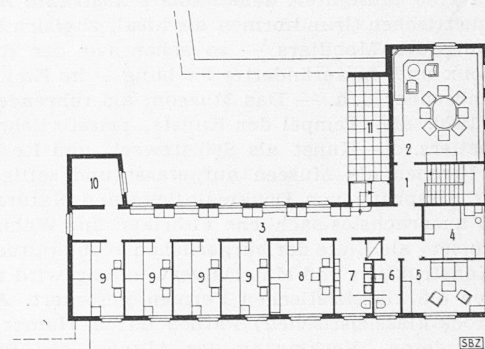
Grundriss des Obergeschosses, 1:400.
